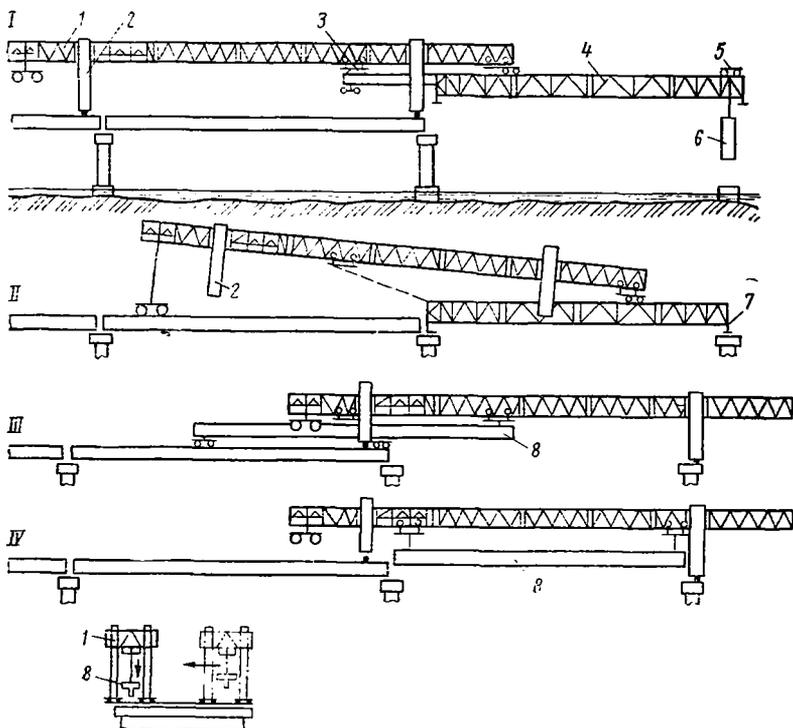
Схема монтажа железобетонного моста агрегатом МШК-100:
